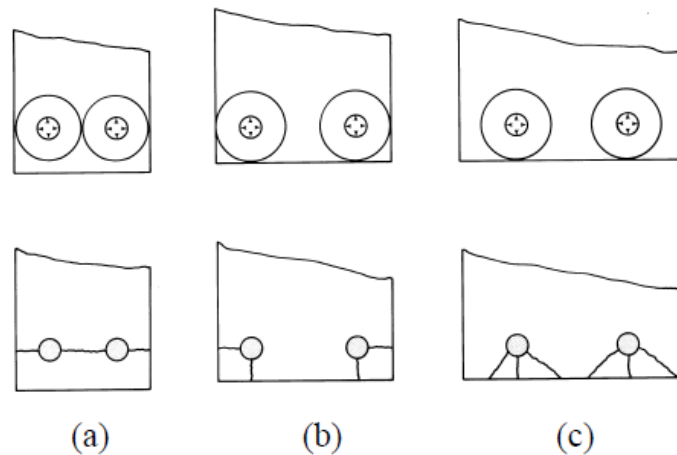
Fissuras de fendilhamento (MACGREGOR, 1988)
